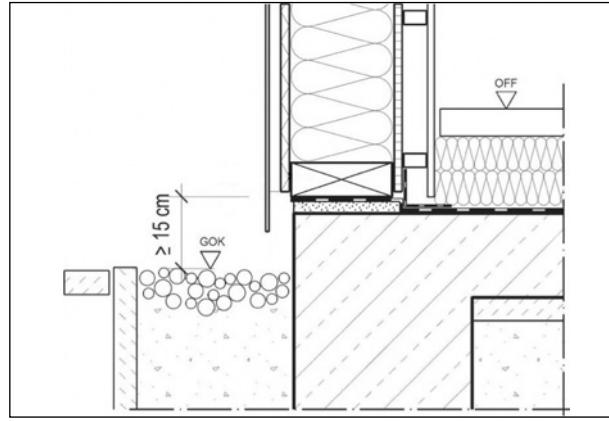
■ Sockelausbildung: Abstand zwischen Unterkante Holzbauteil und Gelände ≥ 15 cm bei Verwendung einer Kiesrollsicht; nach DIN 68800-2 ([28], S. 102)
